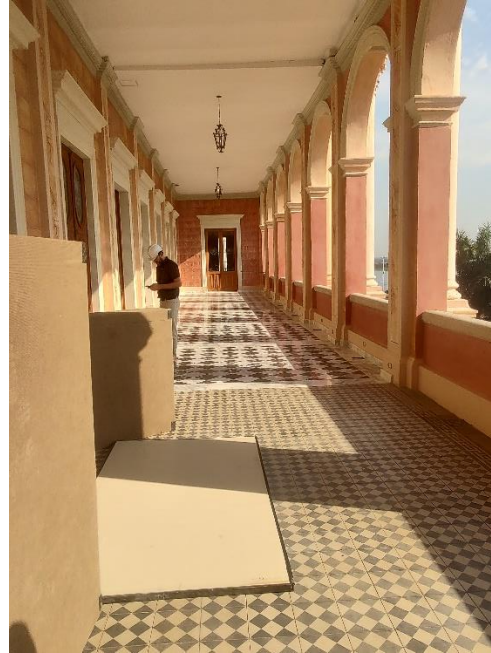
La restauración del salón principal del primer piso restaurado completamente.
